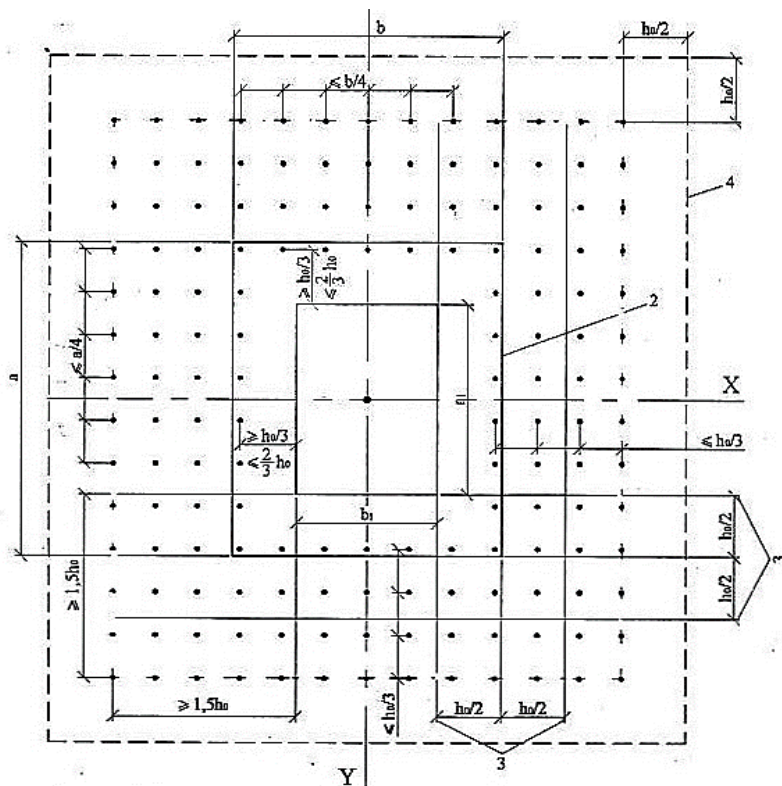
Схема для расчета железобетонных плит с вертикальной равномерно распределенной поперечной арматурой на продавливание
